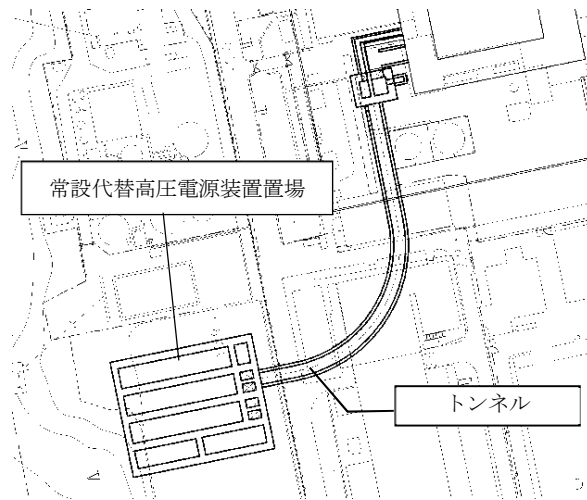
(1) 常設代替高圧電源装置置場とトンネルの平面配置図
